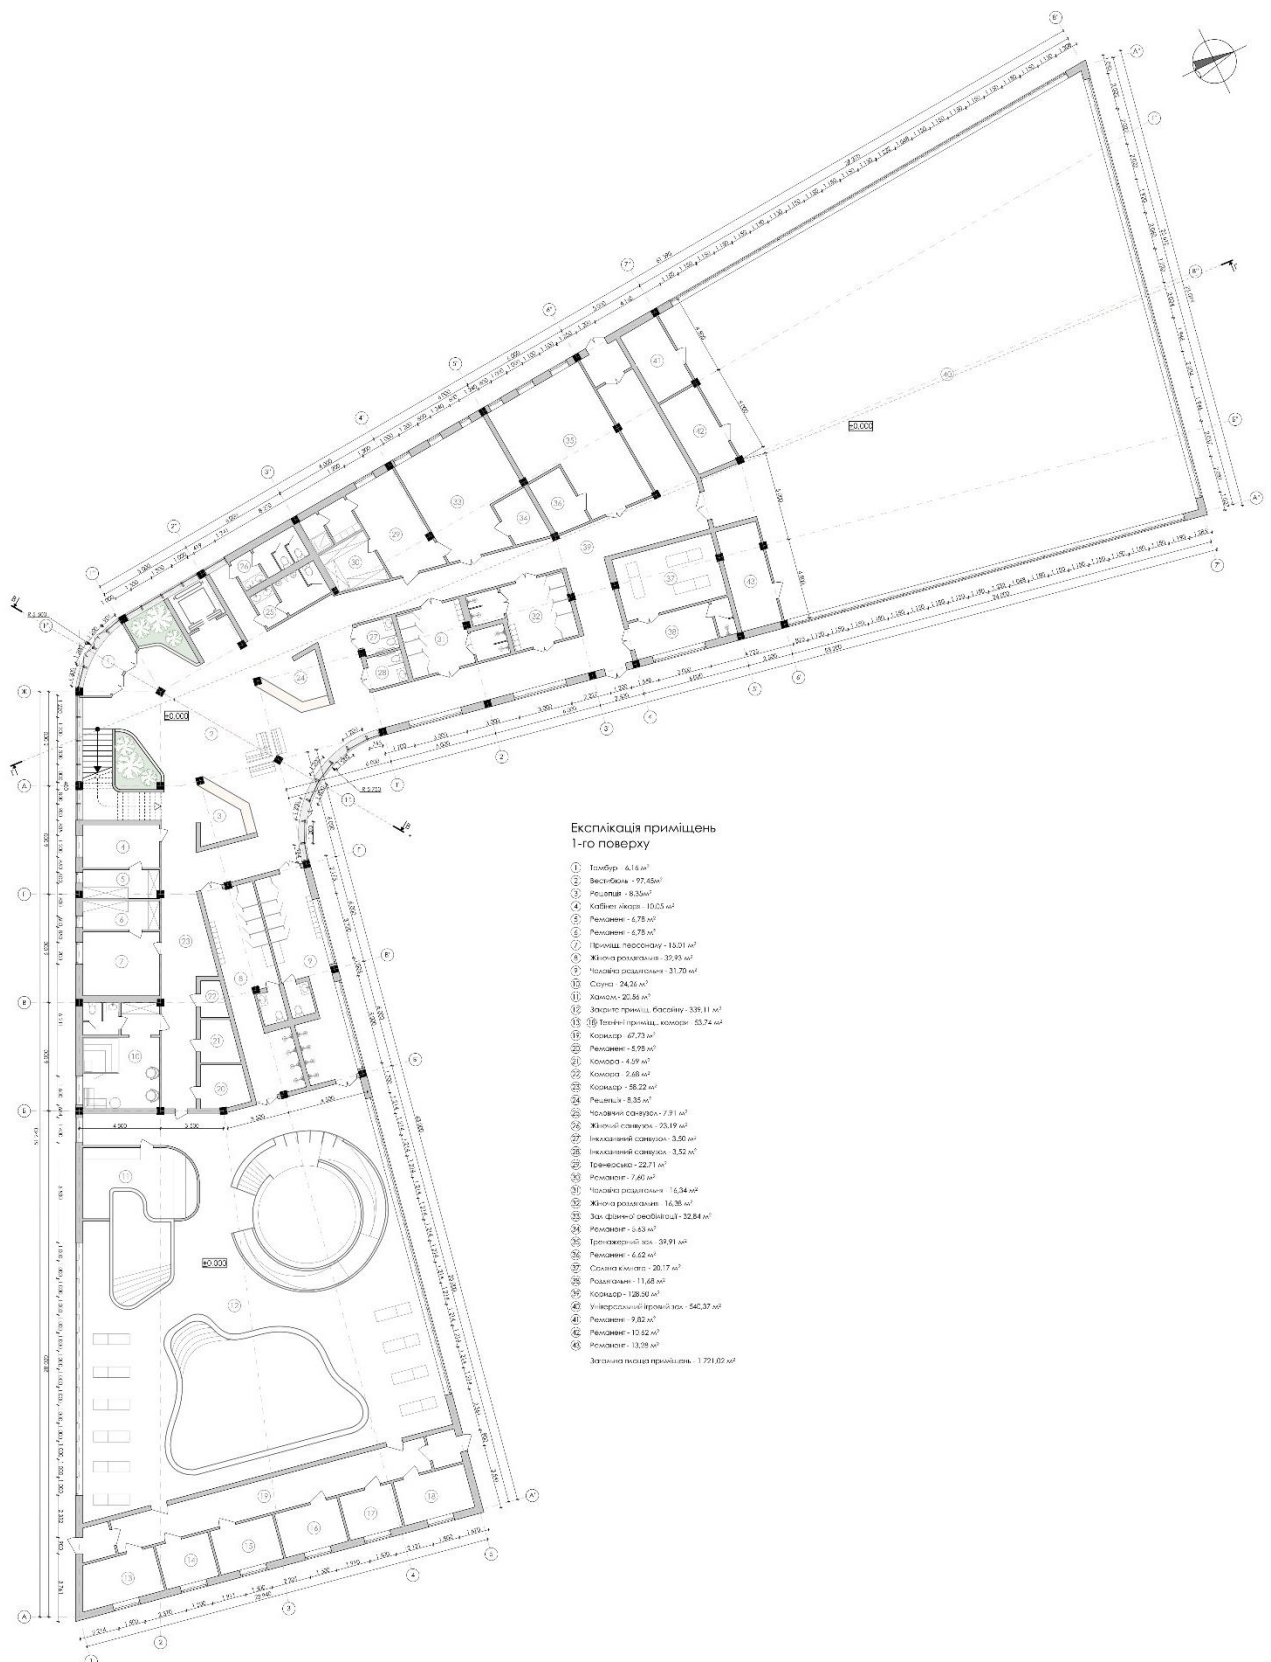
Спортивно-оздоровчий корпус. План першого поверху
